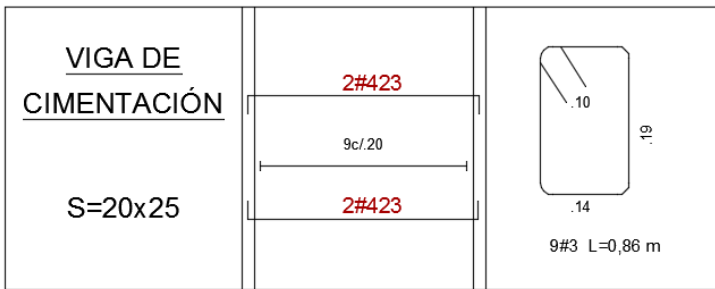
Esquemas del despiece de la viga de cimentación de los muros.
